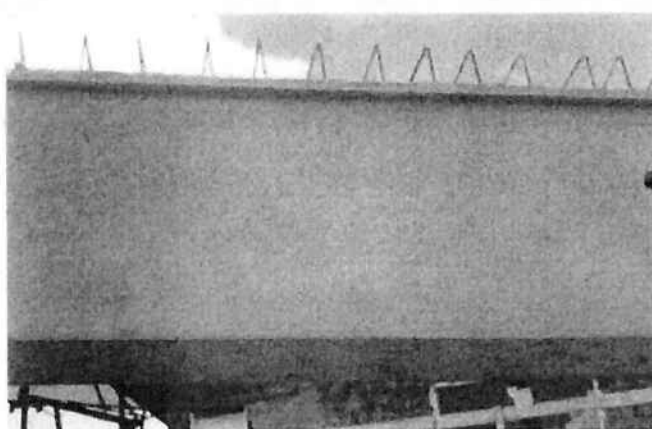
Detalhe da aba da pré-viga periférica à estrutura
